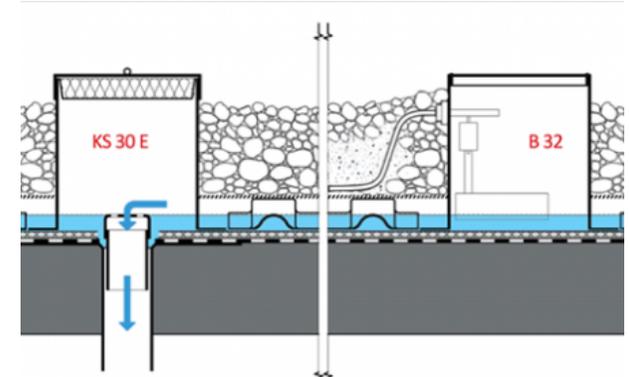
Funcionamiento sistema aljibe Fuente: Guía de planificación. Cubiertas verdes 4.0, Zinco
